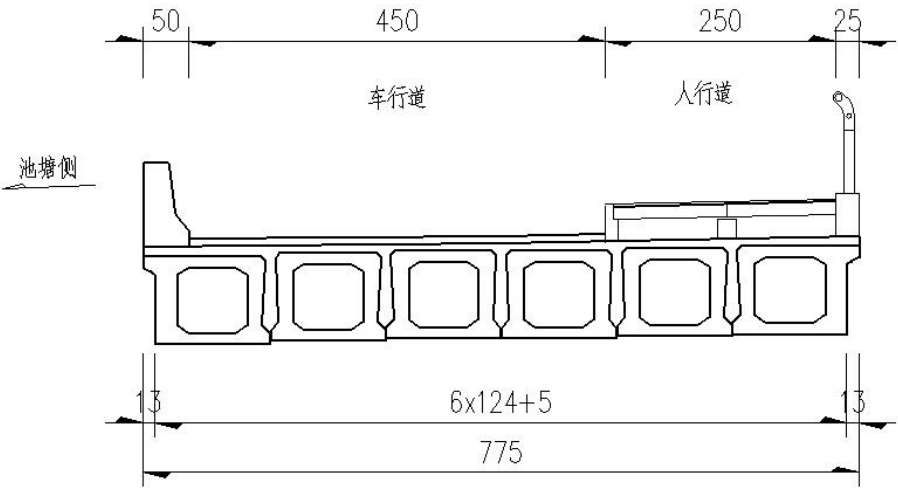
K0+77 桥梁横断面图（单位：cm）
